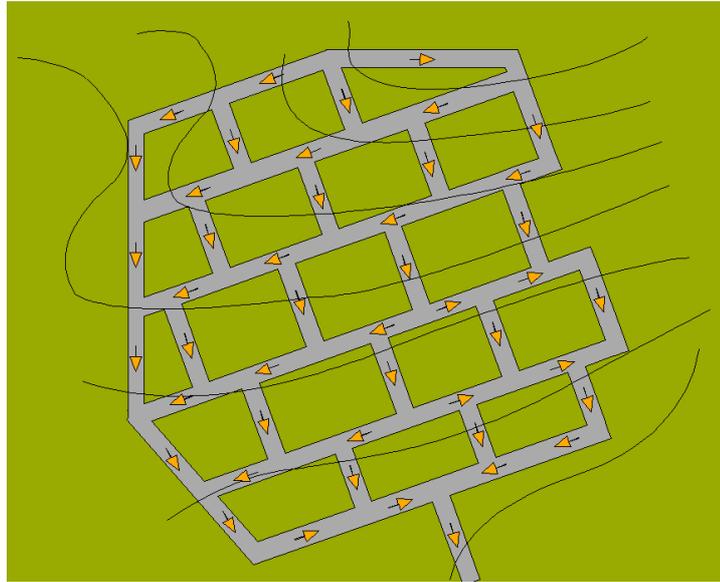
Planta esquemática de malha urbana com indicação do escoamento das águas pluviais em ruas desencontradas
